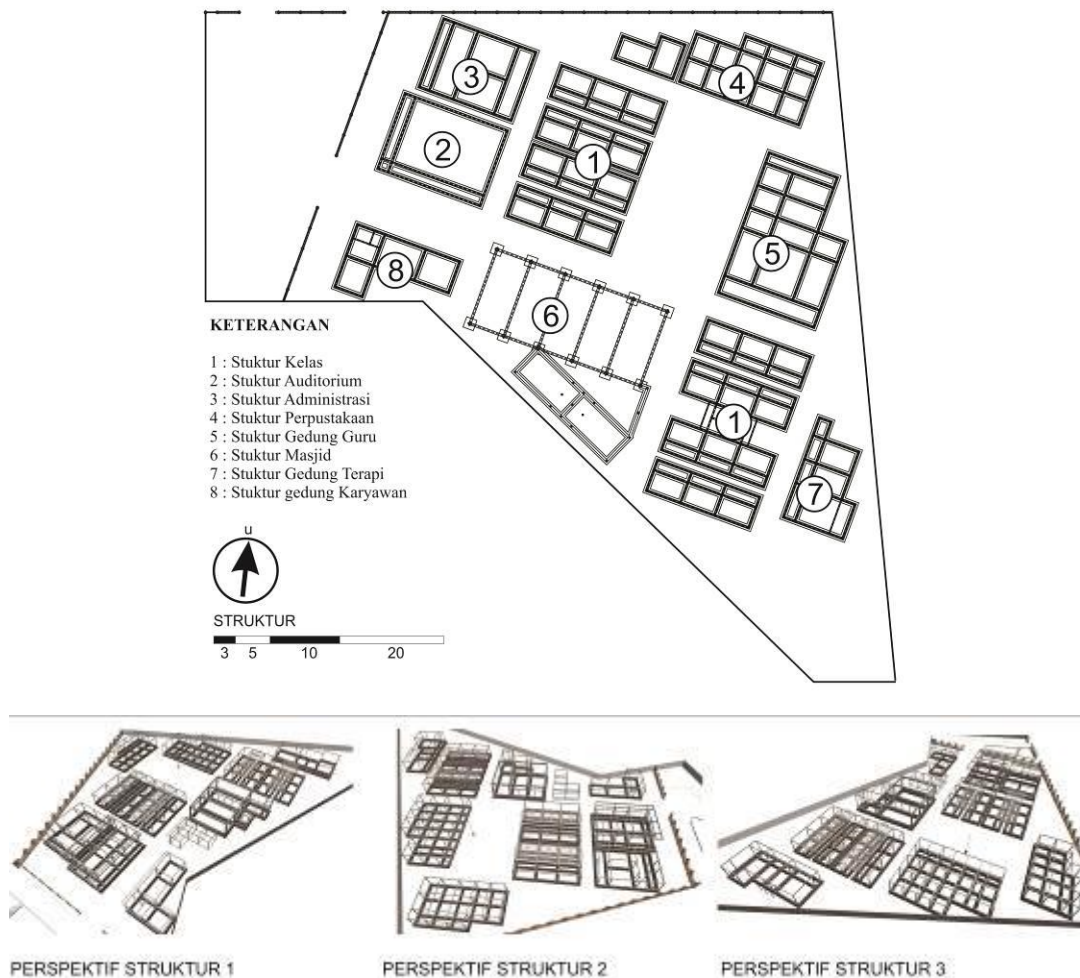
35 Rancangan skematik siteplan SLB Islam Qothrunnada Banguntapan Bantul
